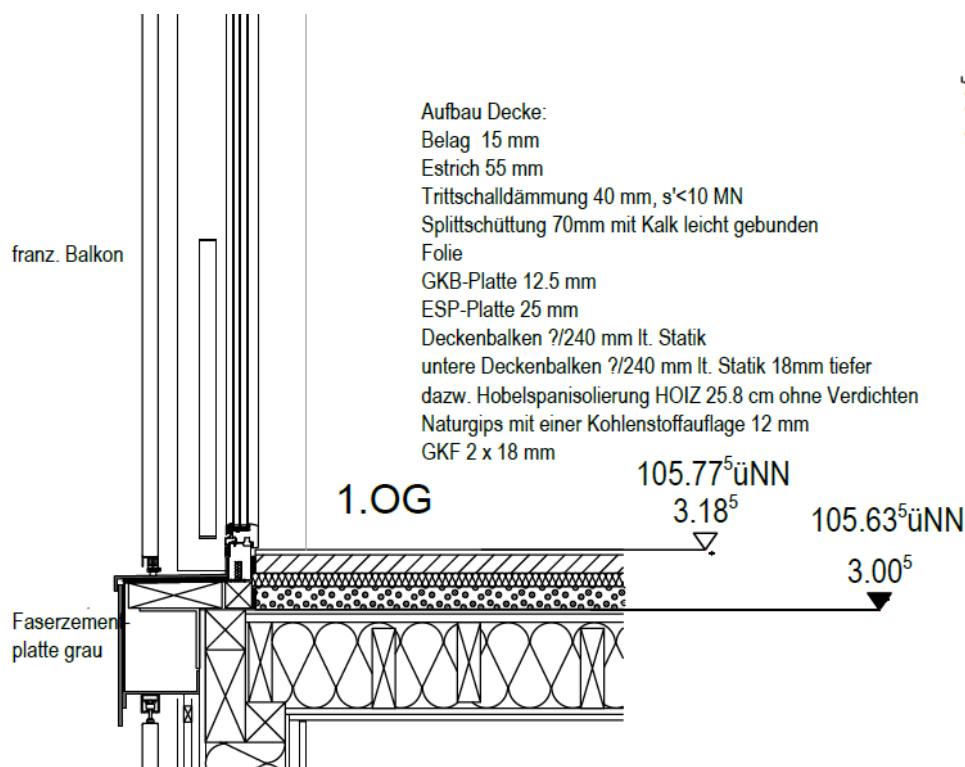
Deckenaufbau Holzbalkendecke mit entkoppelter unteren Balkenlage
